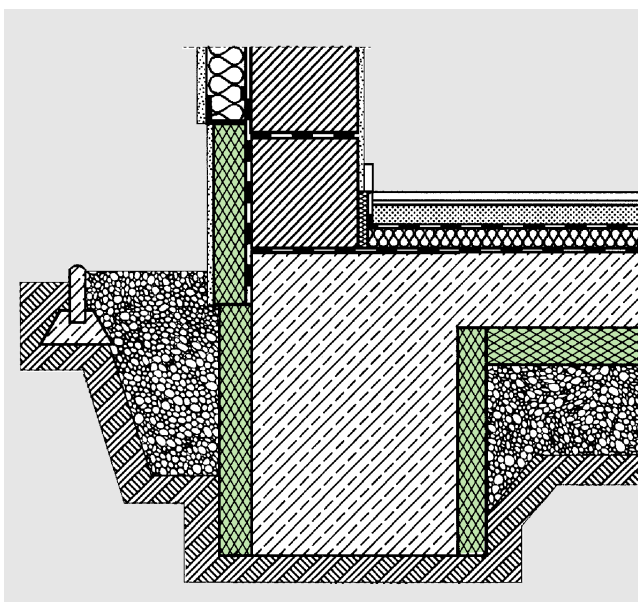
Теплоизоляция фундамента и стык с расположенной снаружи теплоизоляционной соединительной системой.
